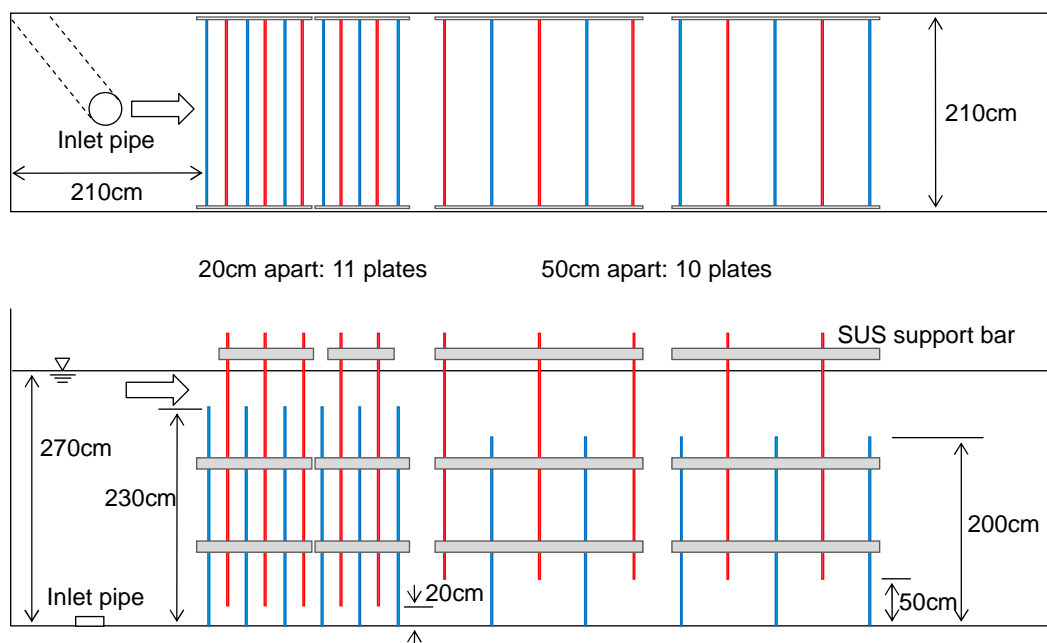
上下迂流式攪拌装置図(上:平面図、下:断面図)
